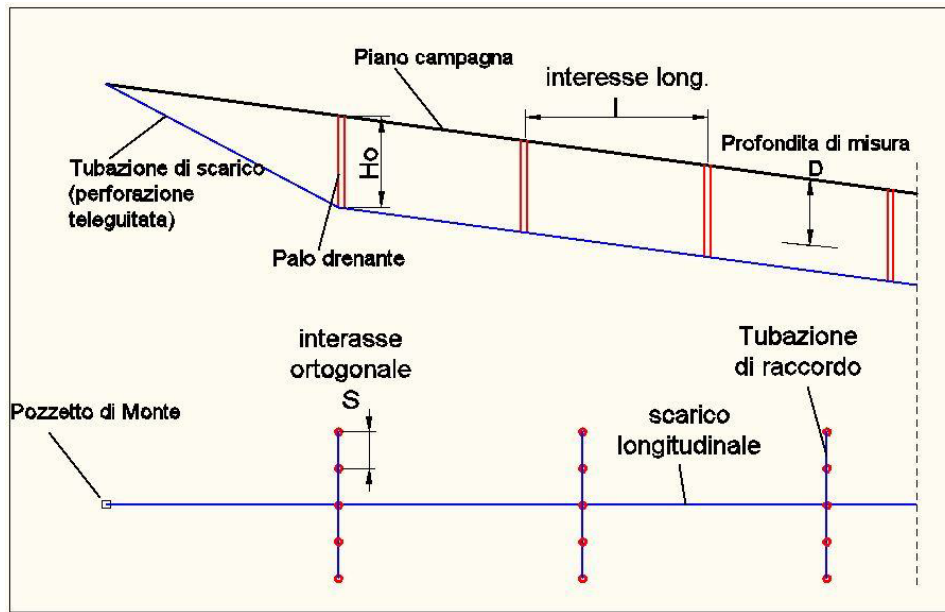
schema di intervento con pozzi drenanti (Aloi et al., 2012).
